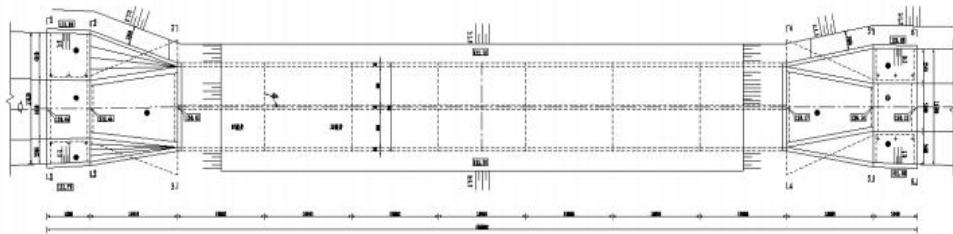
郑州航空实验区段小老营沟 1#涵洞平面图
